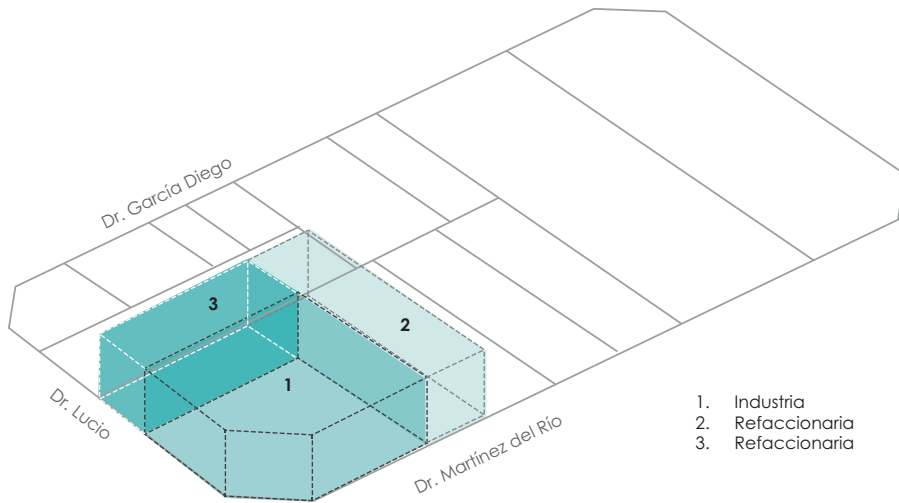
Plano ubicación del predio dentro del Plan Maestro
